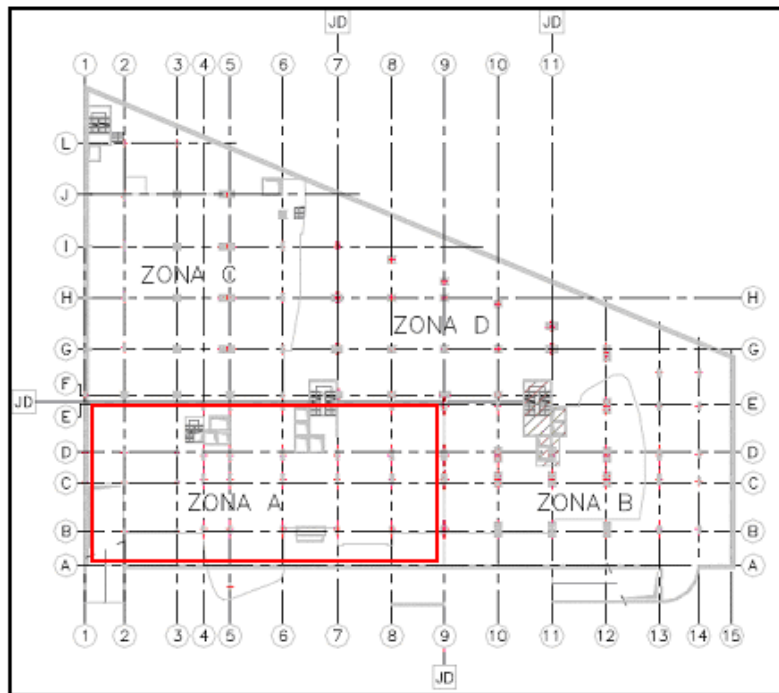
Localização da zona em estudo (Planta Piso 0).
